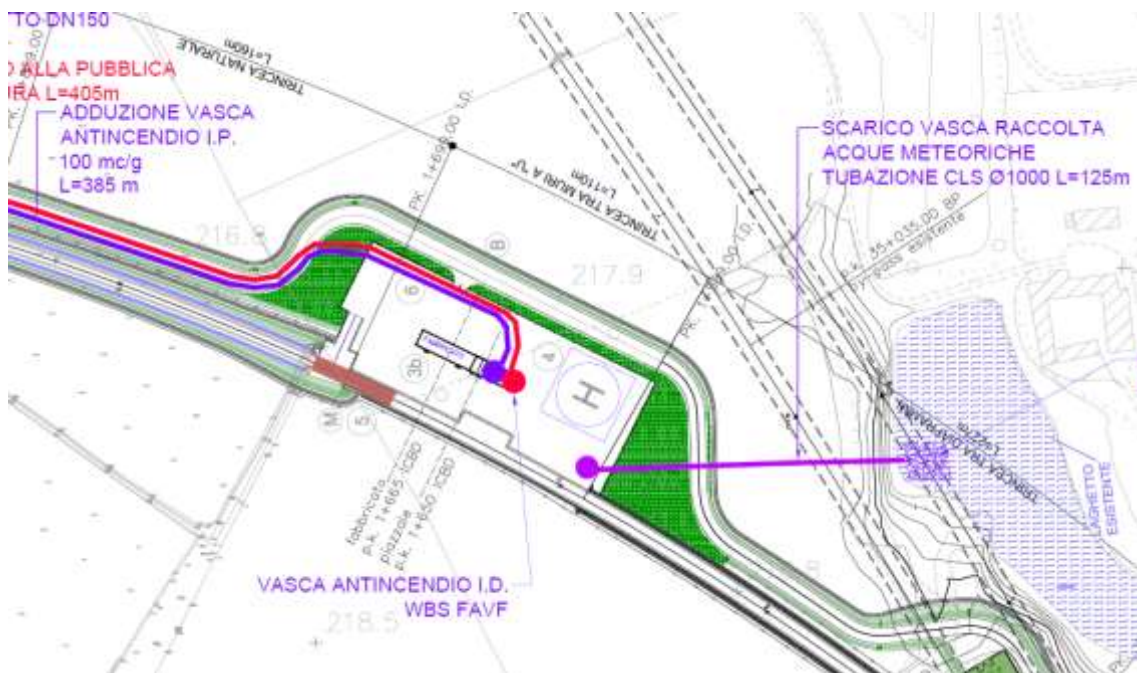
Progetto approvato – piazzale INVI - Pianta
